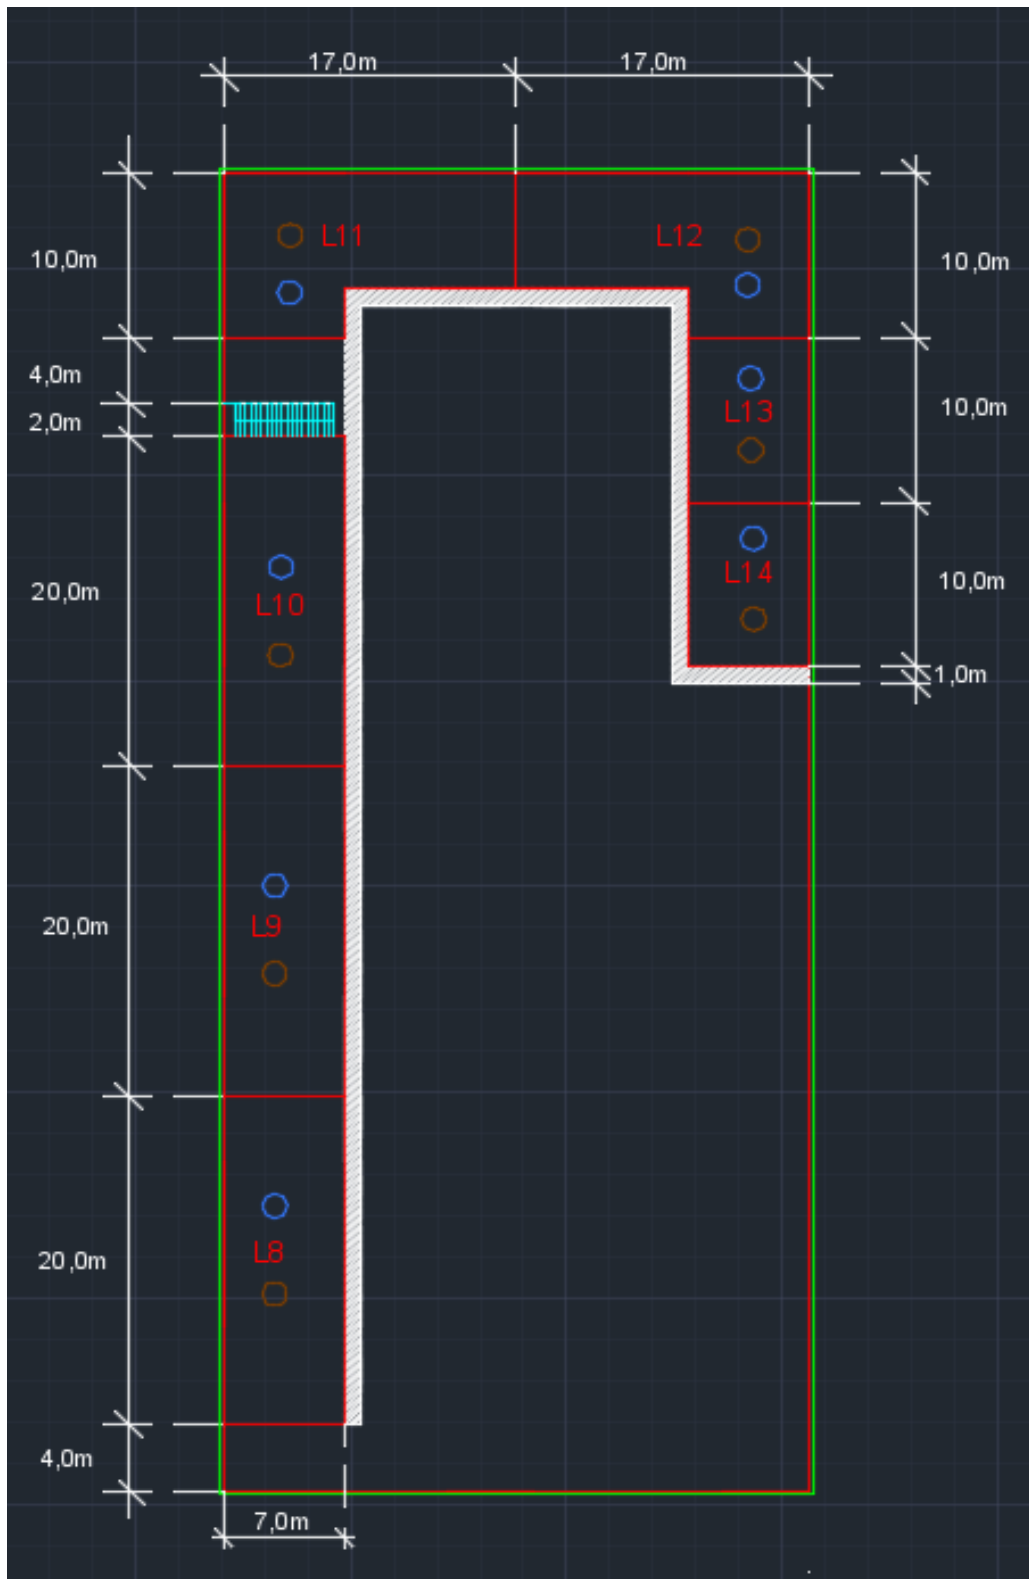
Planta do 2º pavimento do centro comercial (Autoria própria)
